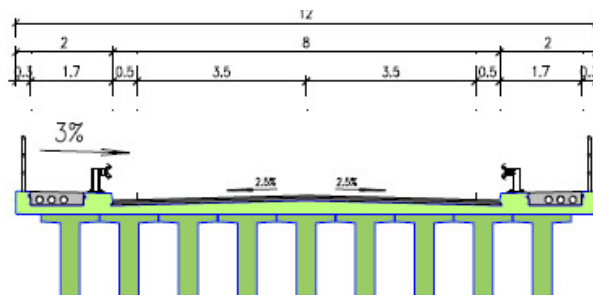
Structura cu grinda din beton precomprimat cu sectiune transversala constanta in forma „T” (tip G)
